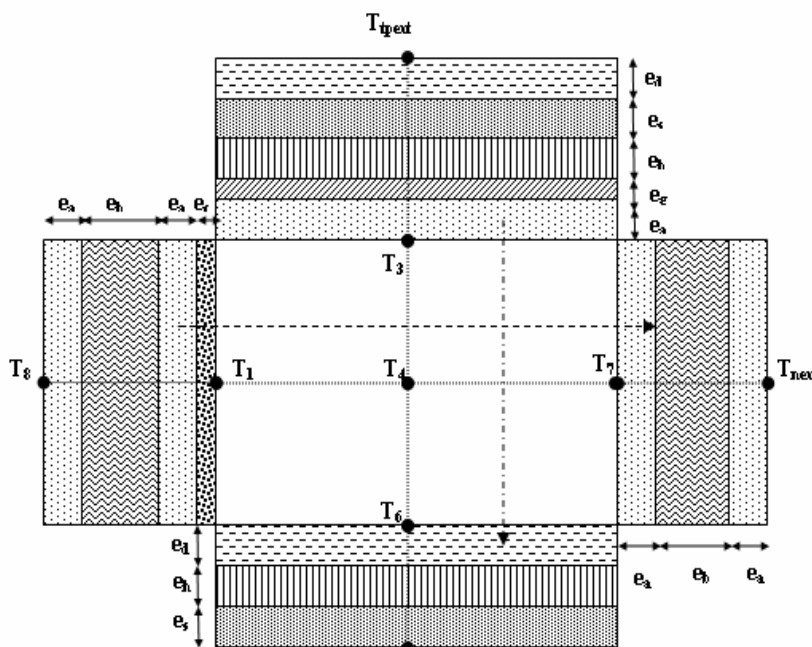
Coupe longitudinale pour l'identification des différentes couches.
